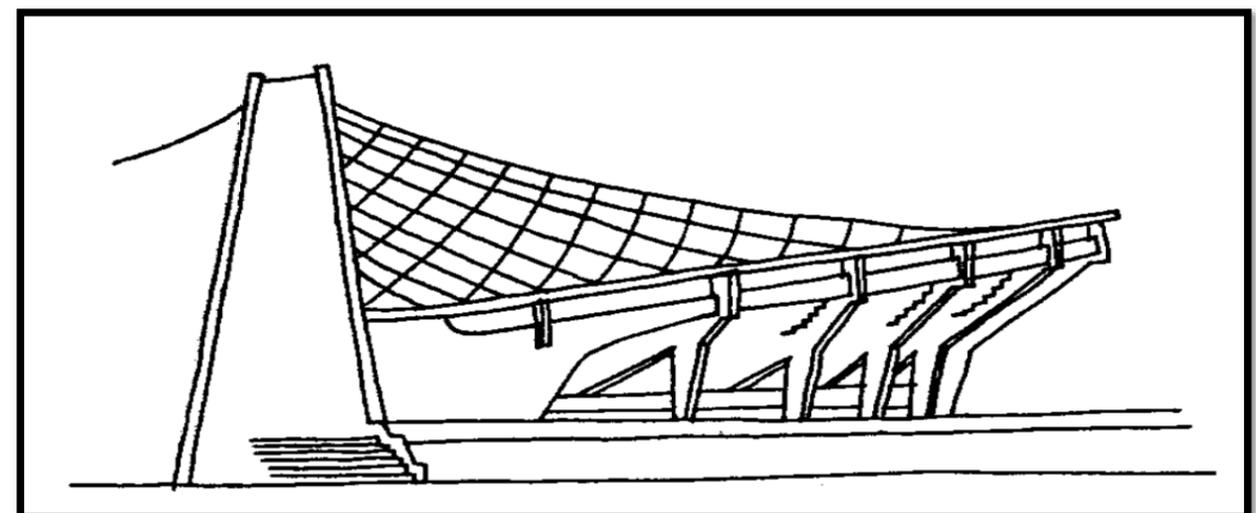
La cubierta colgante, Coliseo Fuente: Comprensión de las estructuras en arquitectura
